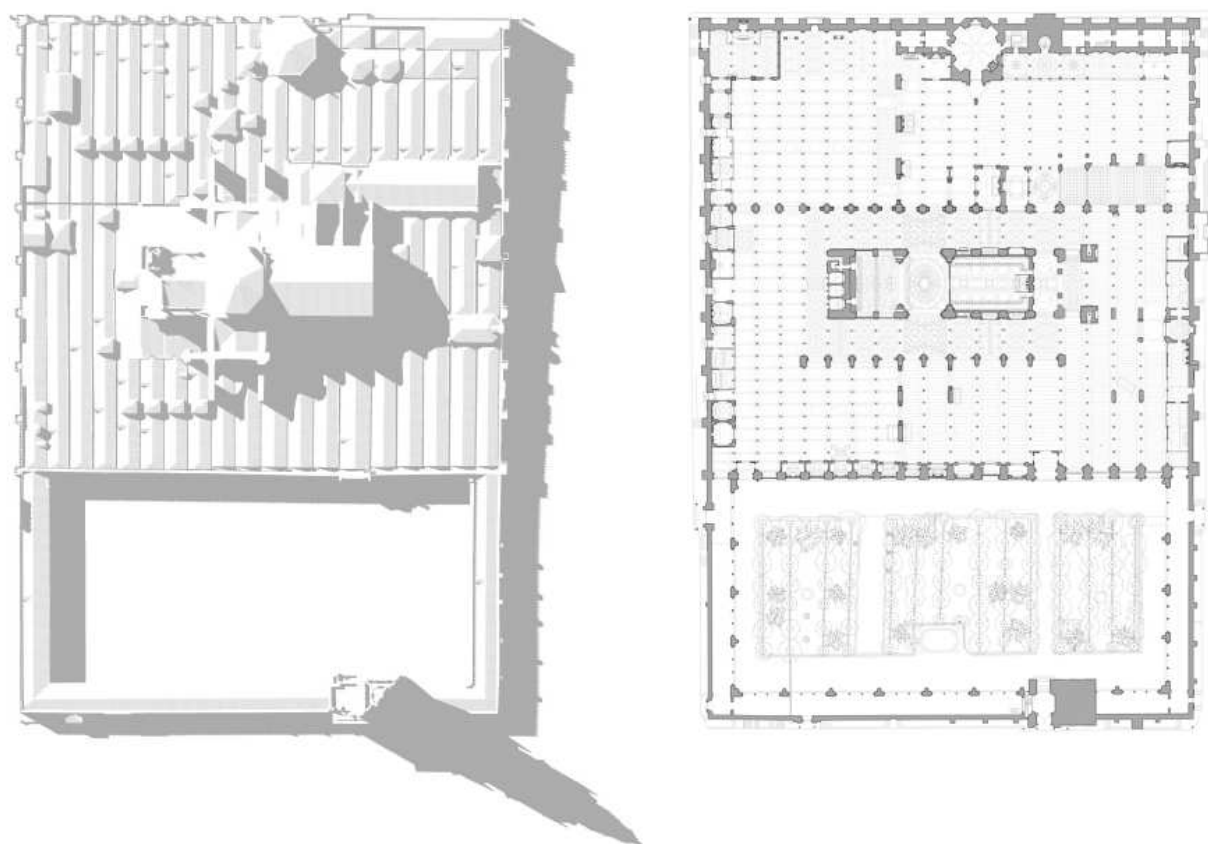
Ruiz Cabrero, G. (2009). Planta de cubiertas y planta baja de la Mezquita-Catedral, escala 1:250.
